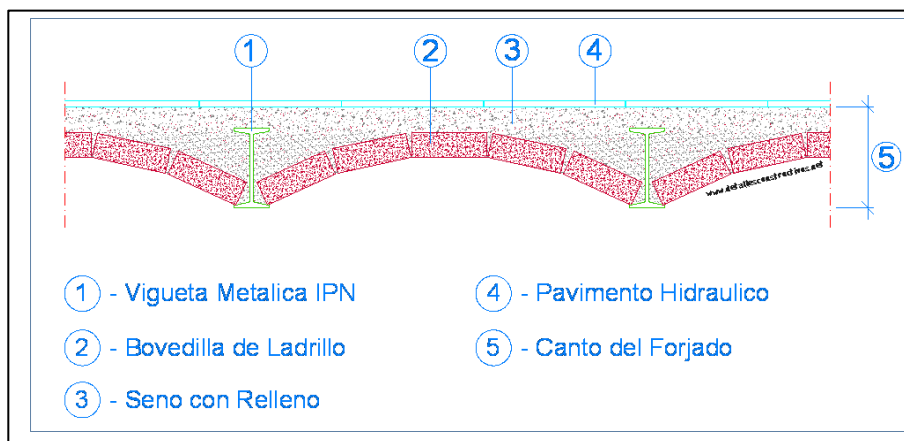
Sección constructiva de forjado unidireccional del Estado Actual
